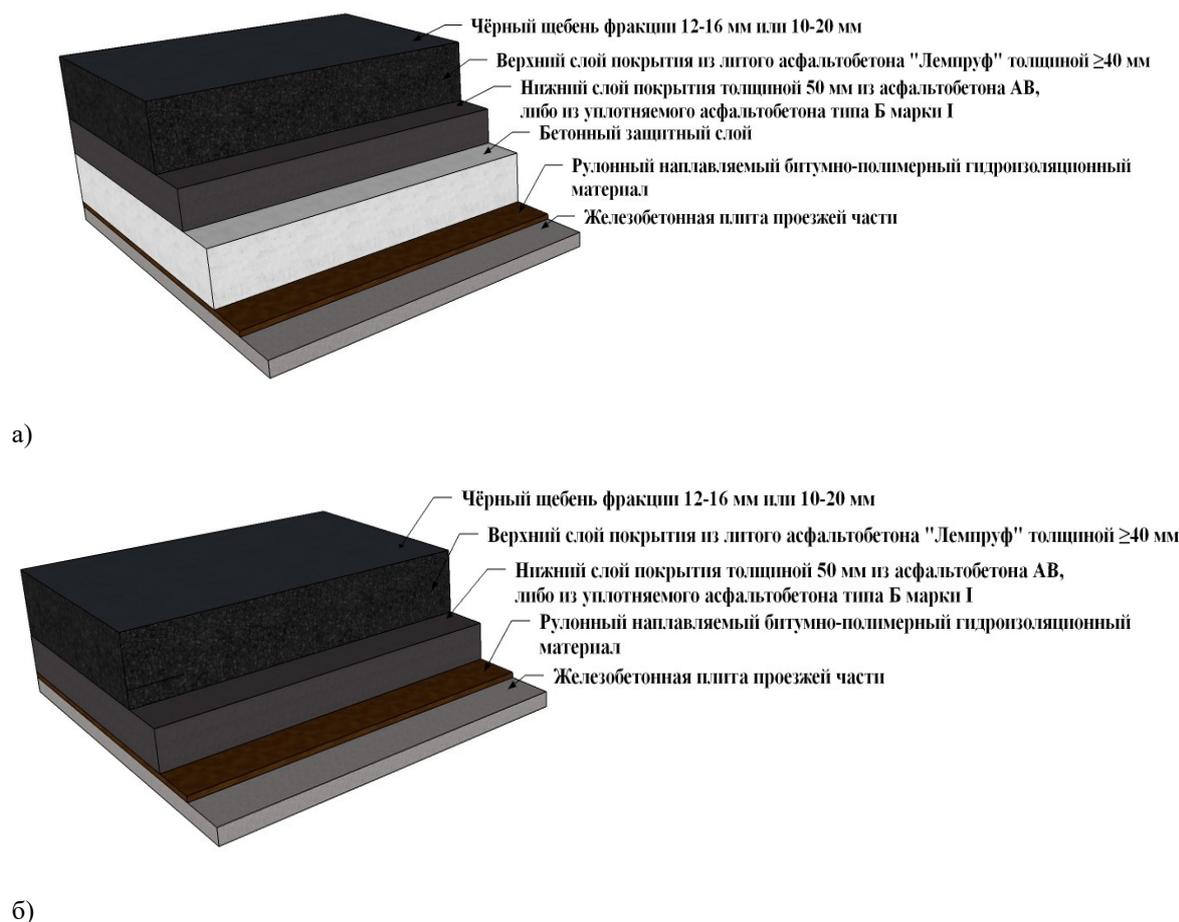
Конструкция дорожной одежды на железобетонной плите:
